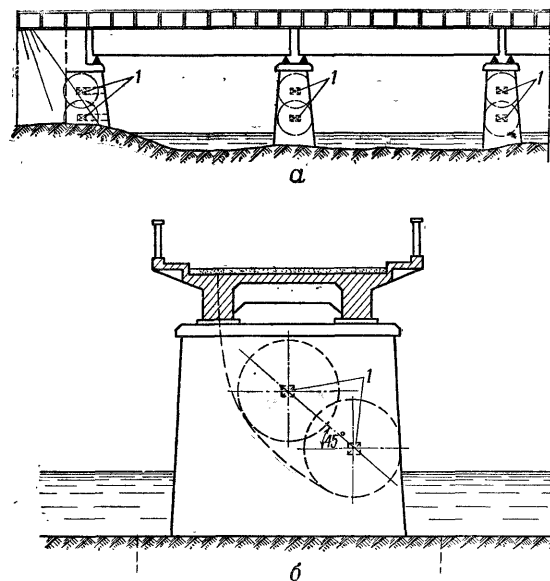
Подрывание балочного железобетонного моста разрезной конструкции:
